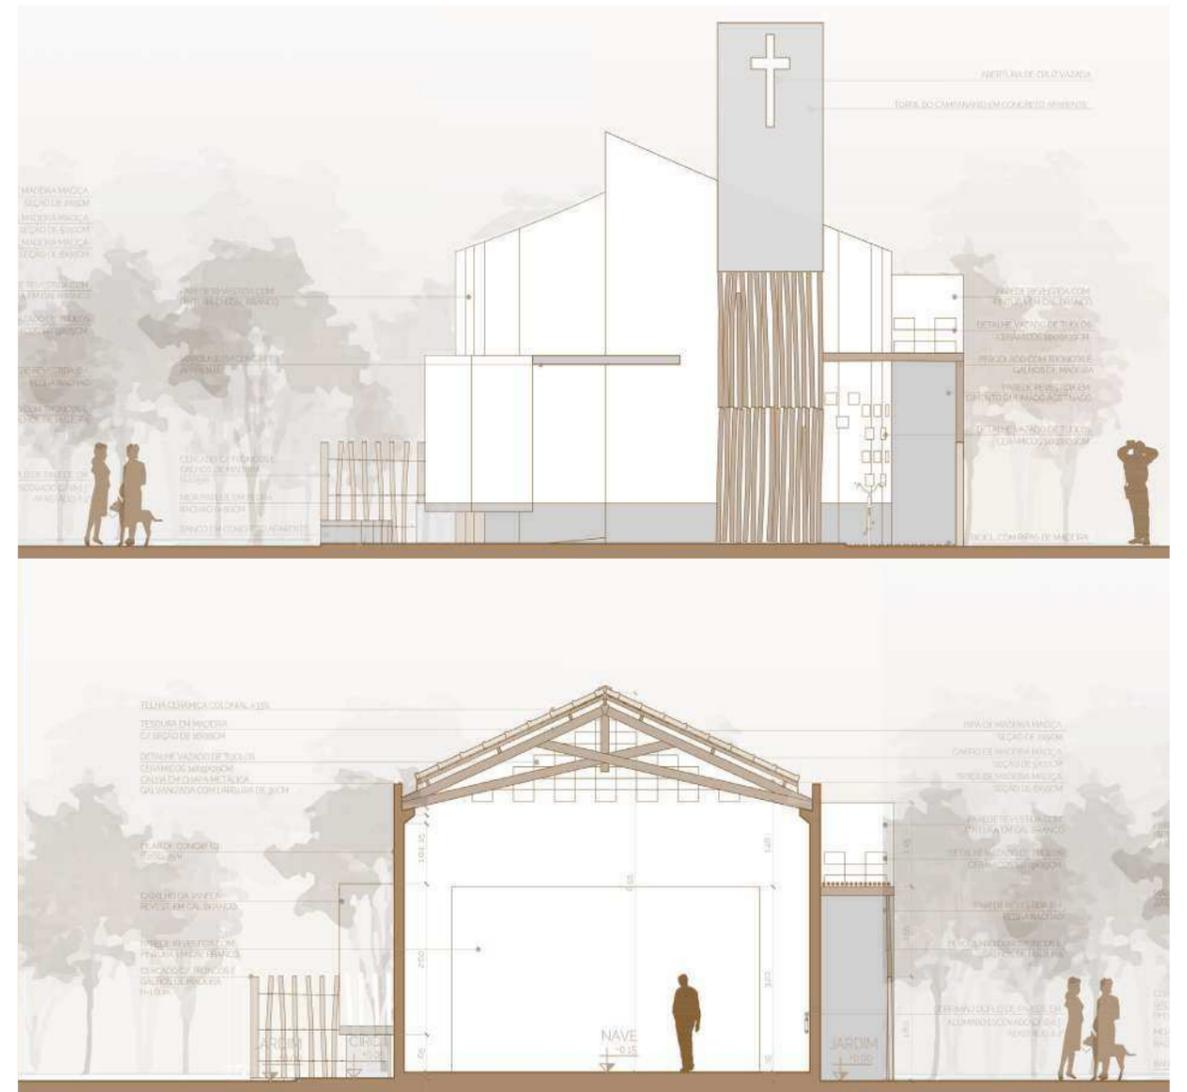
e 48. FACHADA NOROESTE e CORTE B. Fonte: Autora, 2023
